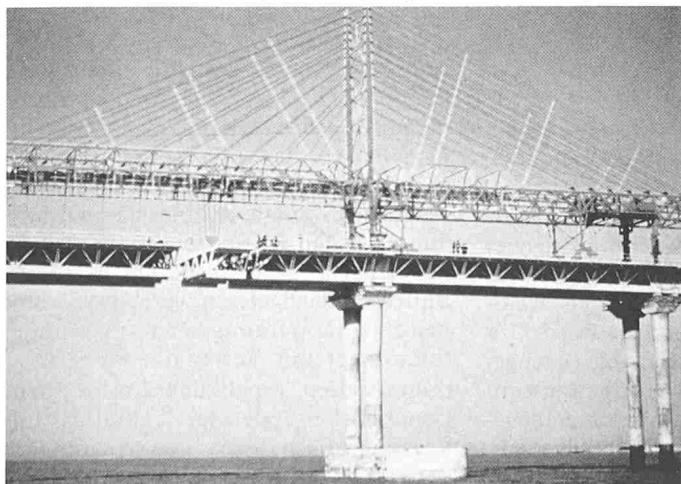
MRT Singapur: Heben eines 165 t schweren Spannbetonkastenträgers
